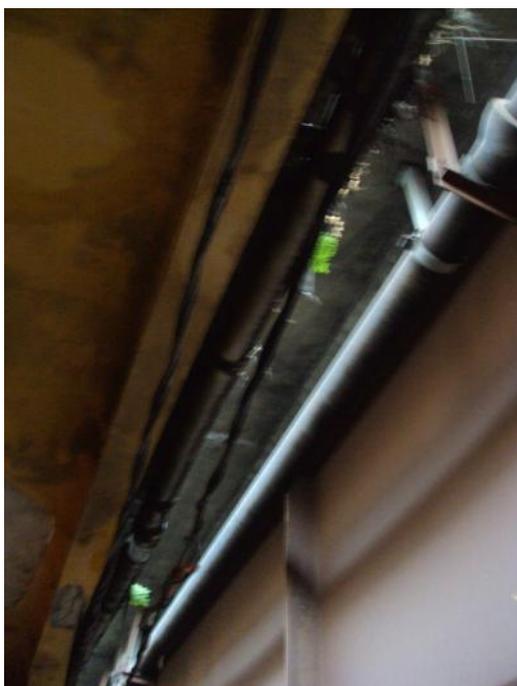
Foto tirada da sacada de um apartamento localizado no 2º pavimento de uma edificação da Rua Bela. Detalhe dos fios de alta tensão que invadem a varanda da residência. Foto da autora (2013).
